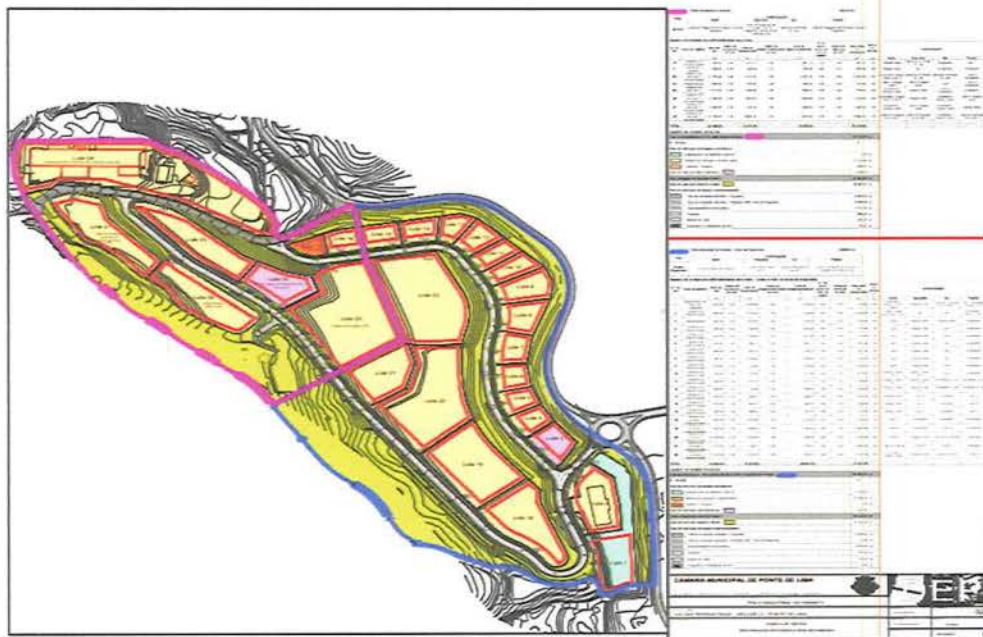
Planta de Síntese do Loteamento do Pólo Industrial do Granito
